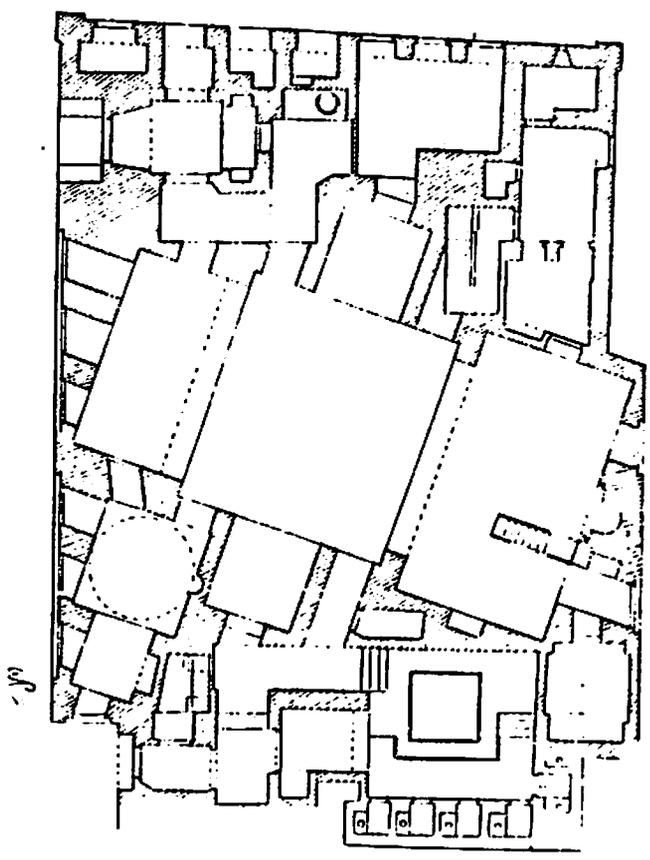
مسقط أفقي لمنشأة النا صر فرج ابن برفوق عن د. صالح لمي مصطفى
